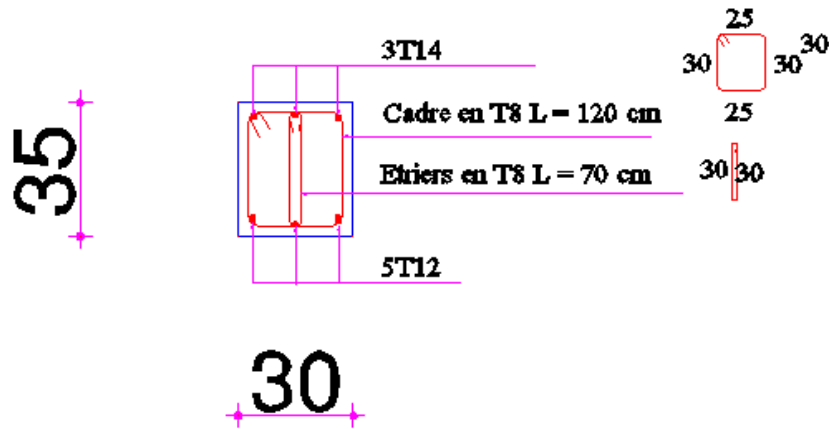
ferrailages des poutres secondaires en travée (30x35)
